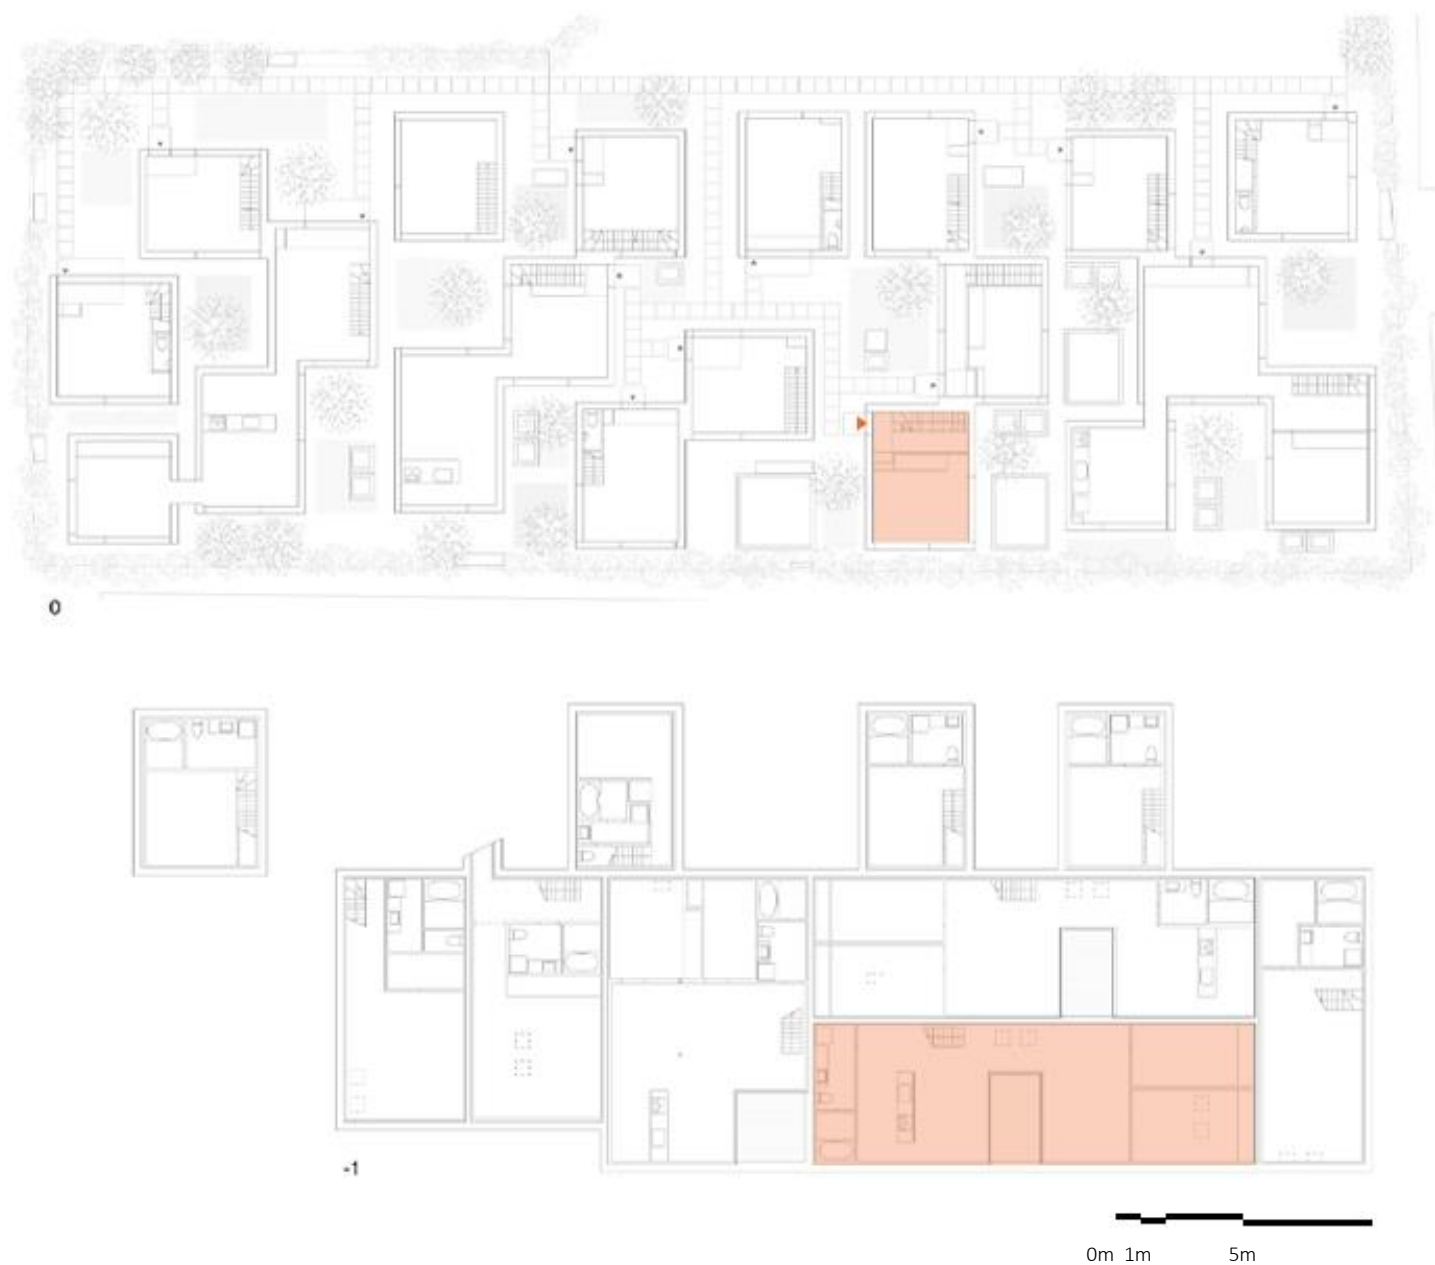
Plans R-1 et R0 de situation du logement B du projet Seijo Town Houses
